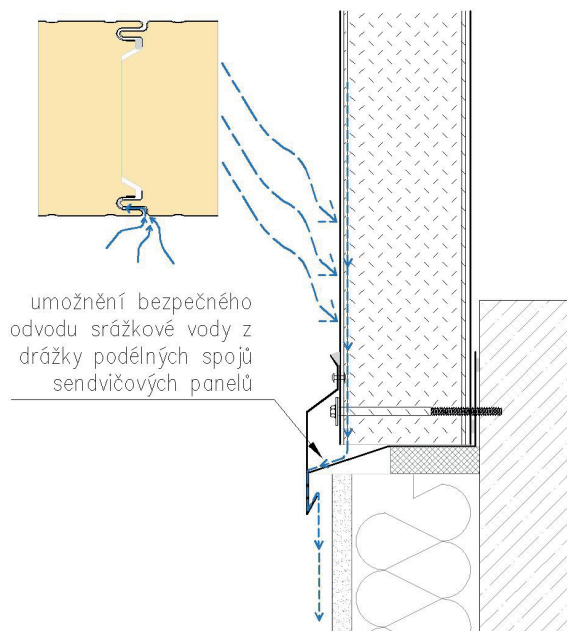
Příklad založení vertikálně kladených panelů s pomocným profilem
